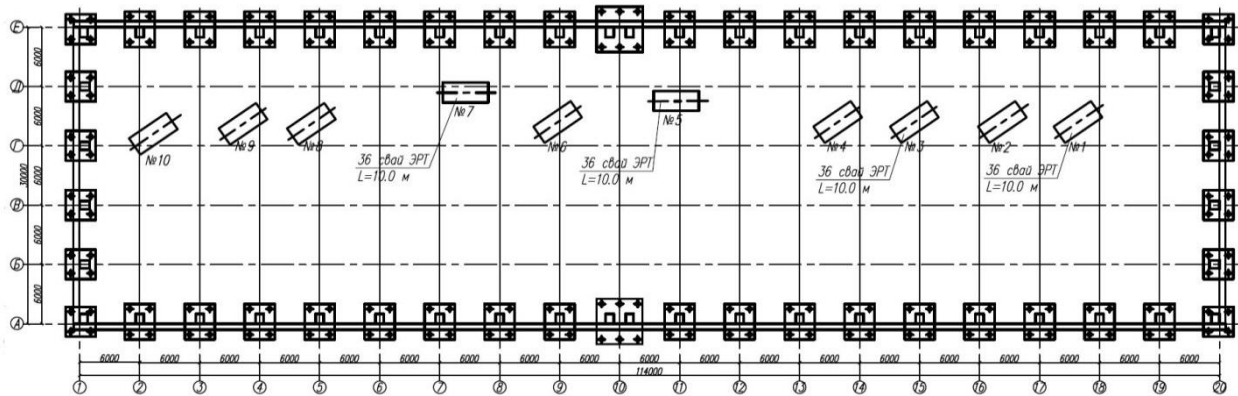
План свайного поля из буринъекционных свай ЭРТ.
